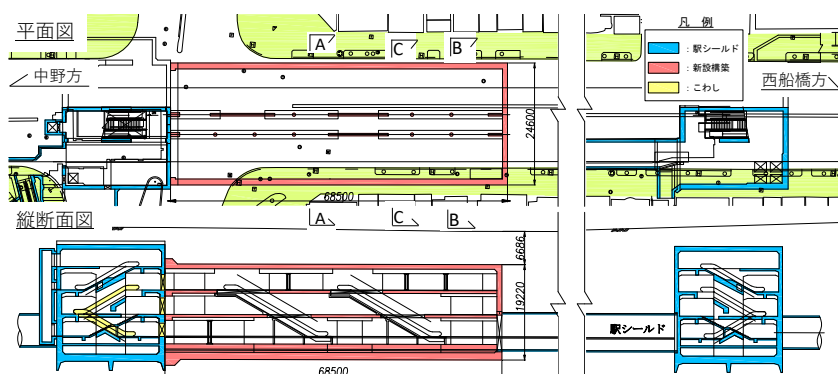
木場駅改良計画平面図（地上及び地下1階）及び縦断面図
